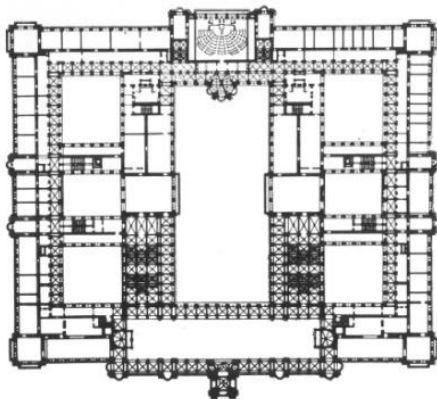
Wien, Rathaus. Grundriß. Friedrich von Schmidt. 1872–1882
